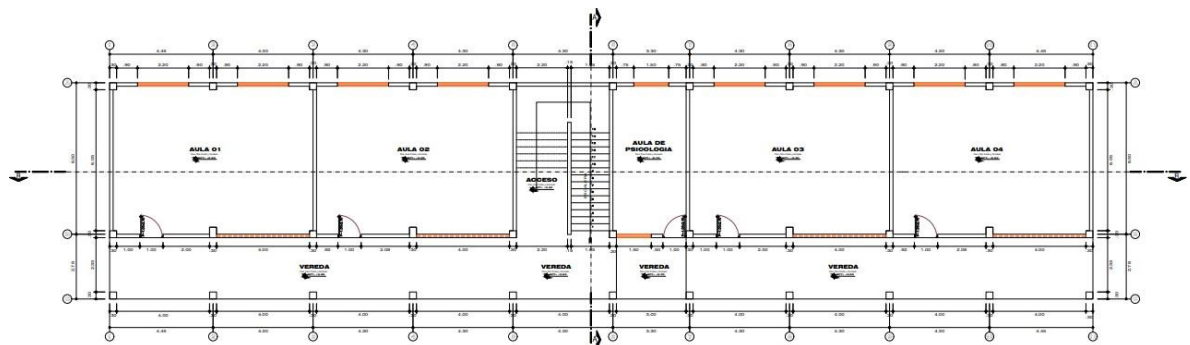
Plano Arquitectónico del pabellón C – Primer piso
